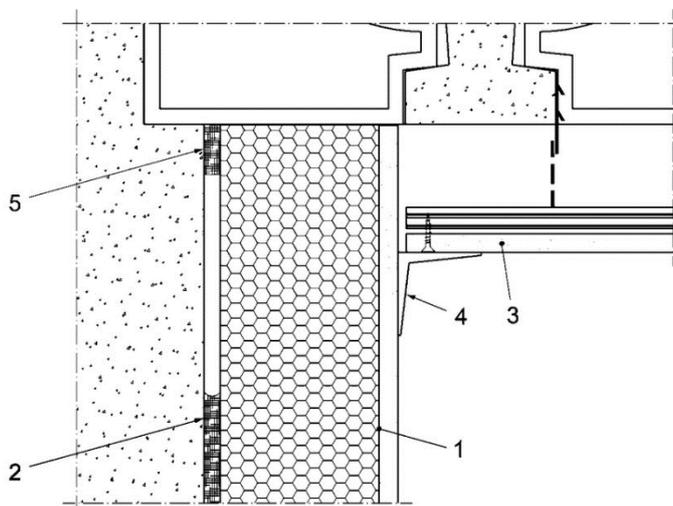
Vue de coupe – Conditions géométriques longitudinales et ferrailage
